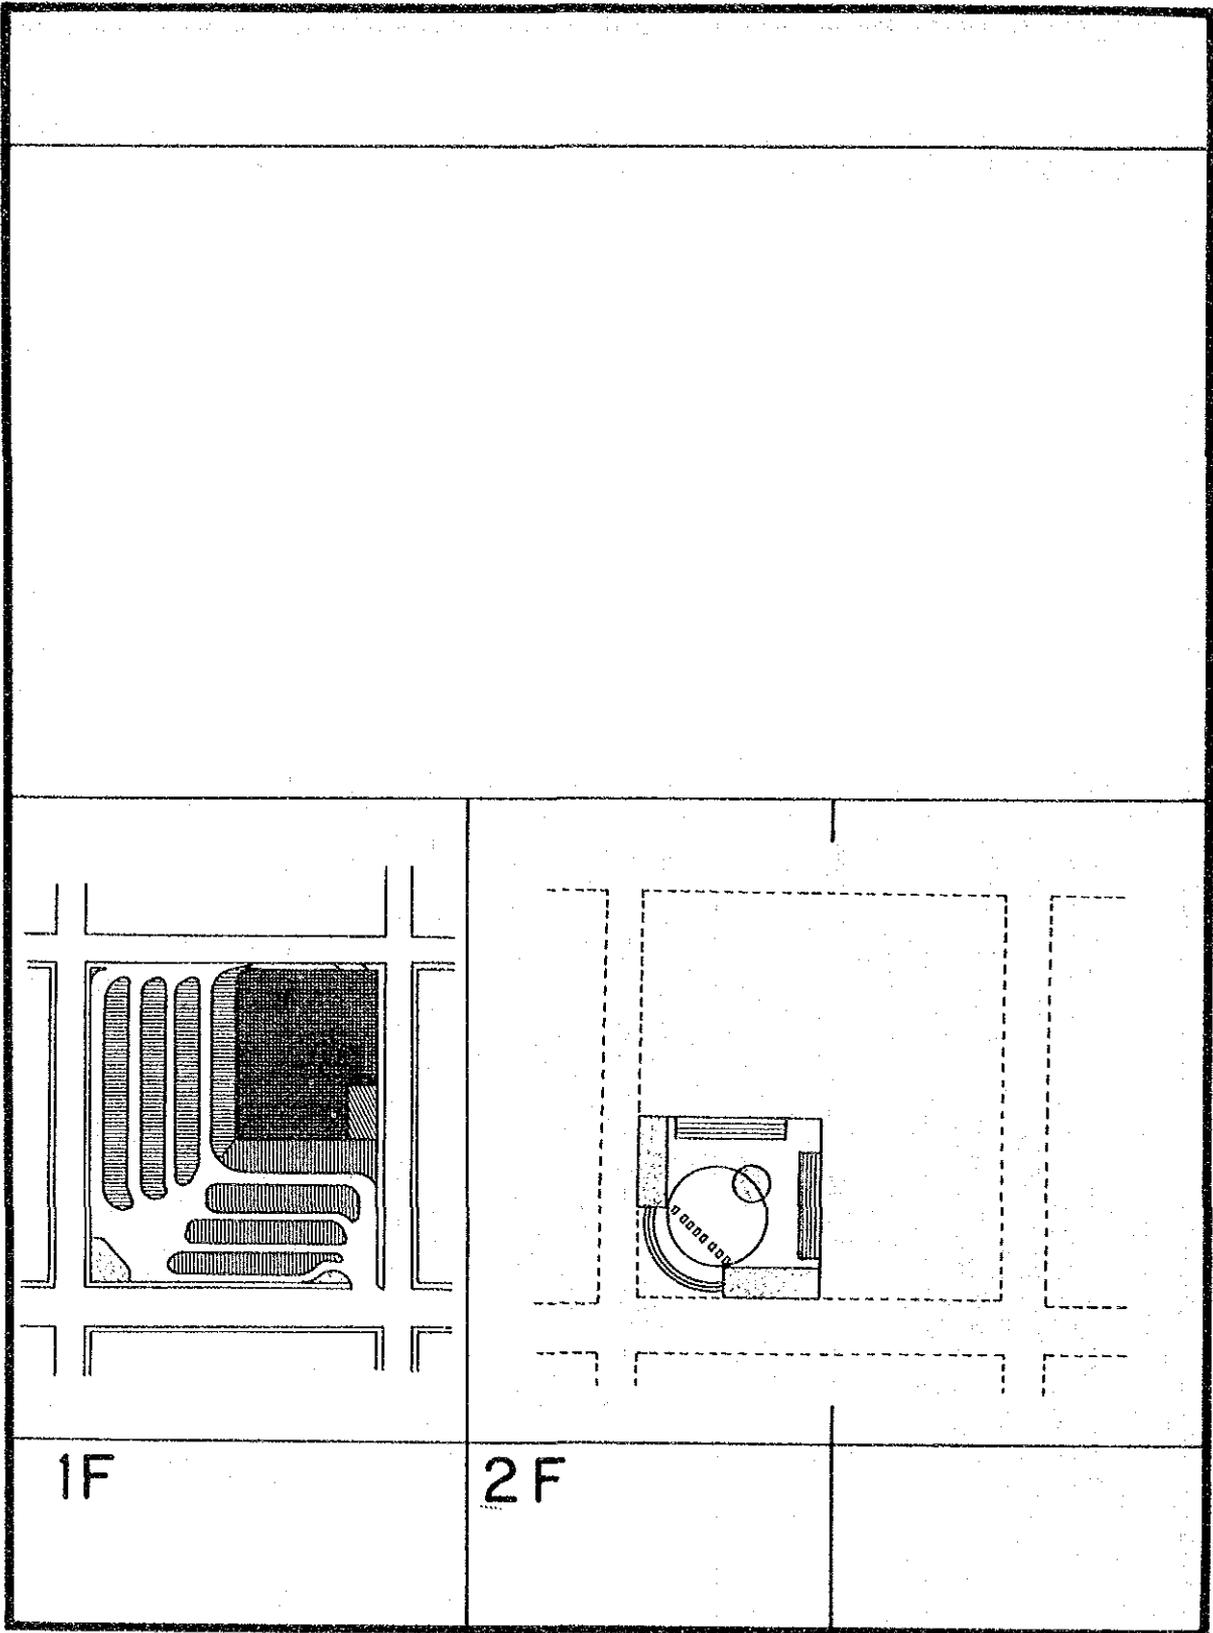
Plan de Terminal de Bus en la Area de Mamonal
